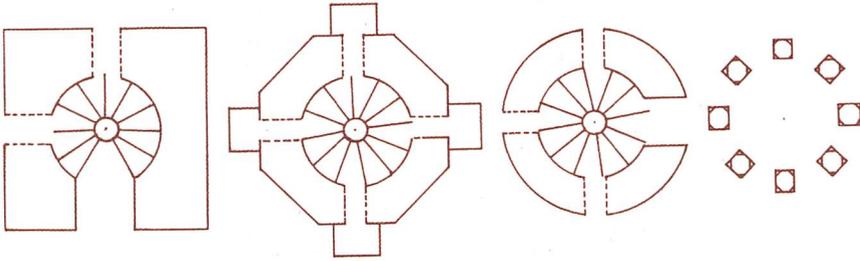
المسقط الأفقى لمسجد السلطان حسين بجبارس
